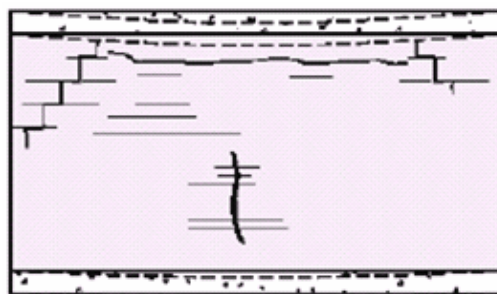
Fissuração do suporte: deformação da viga de apoio menor que a deformação da viga superior [21]
